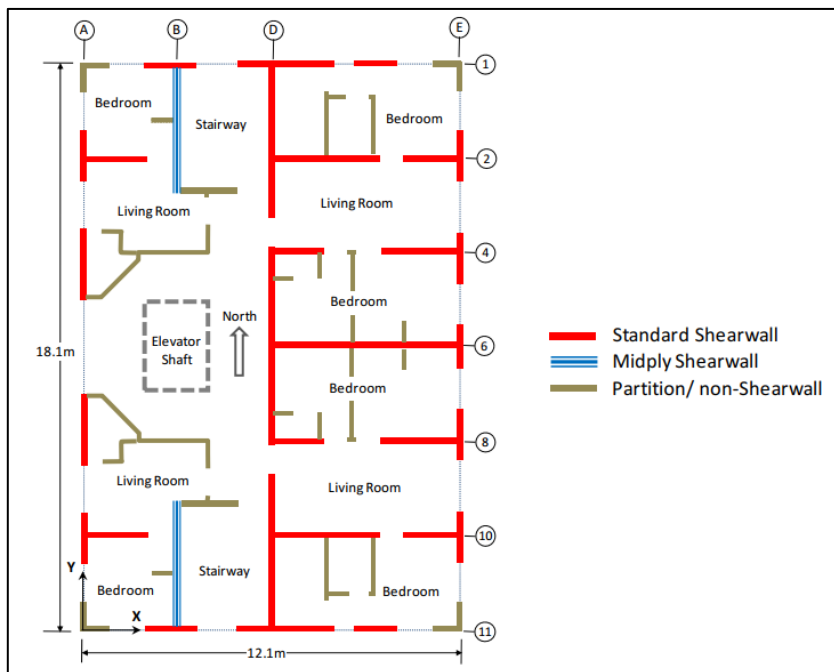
Vista en planta del primer piso edificio NEESWood (Pang et al., 2010)
